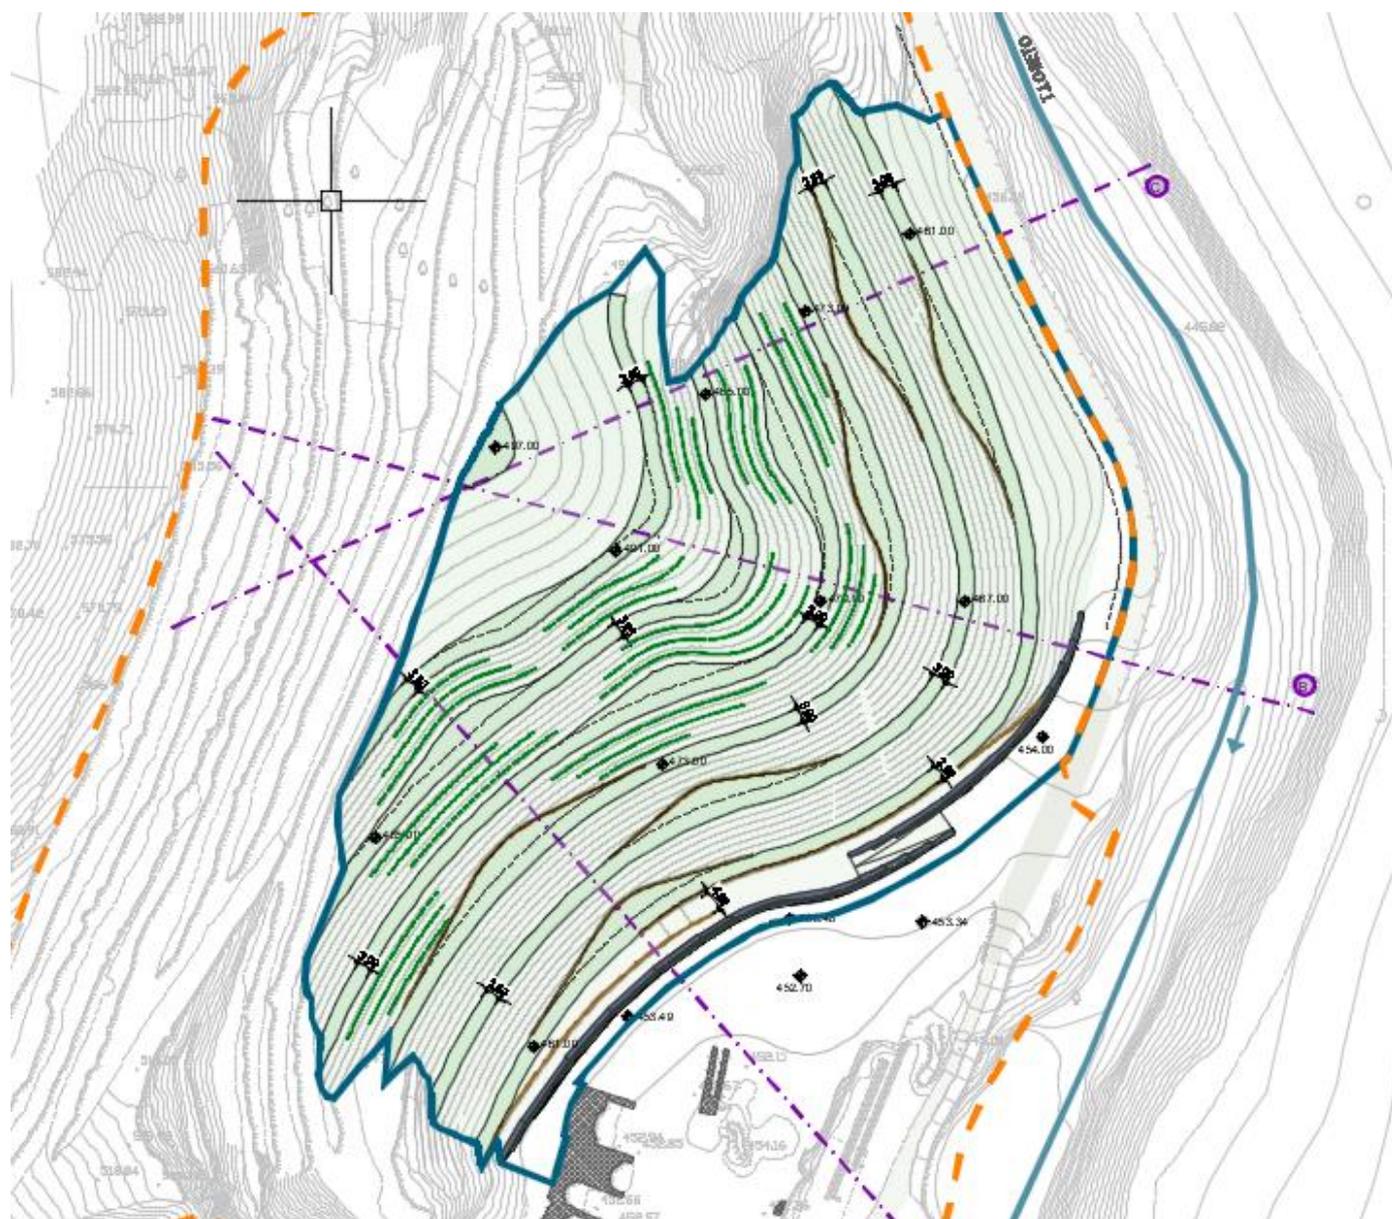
STRALCIO DELLA PLANIMETRIA DI PROGETTO
